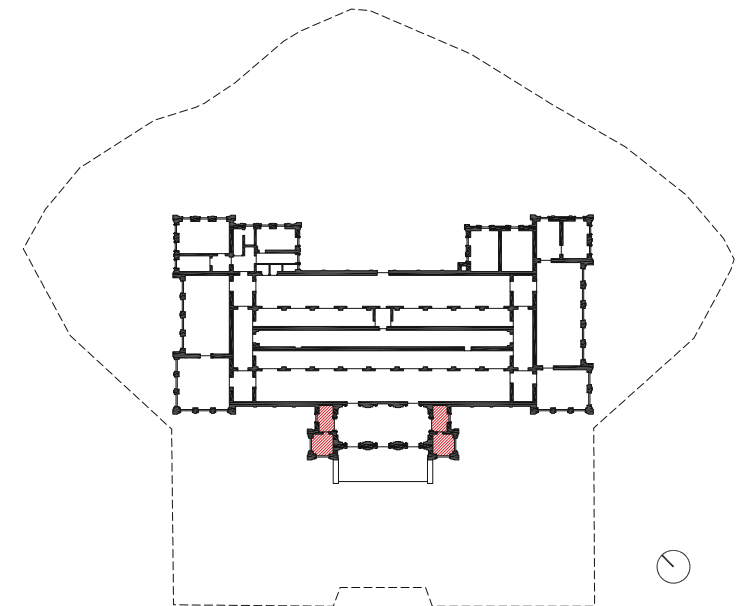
Rekonstruktionsgrundlage West- und Südturm des Mittelrisalits mit Nebenräumen: Lageplan der BVA, um 1905
